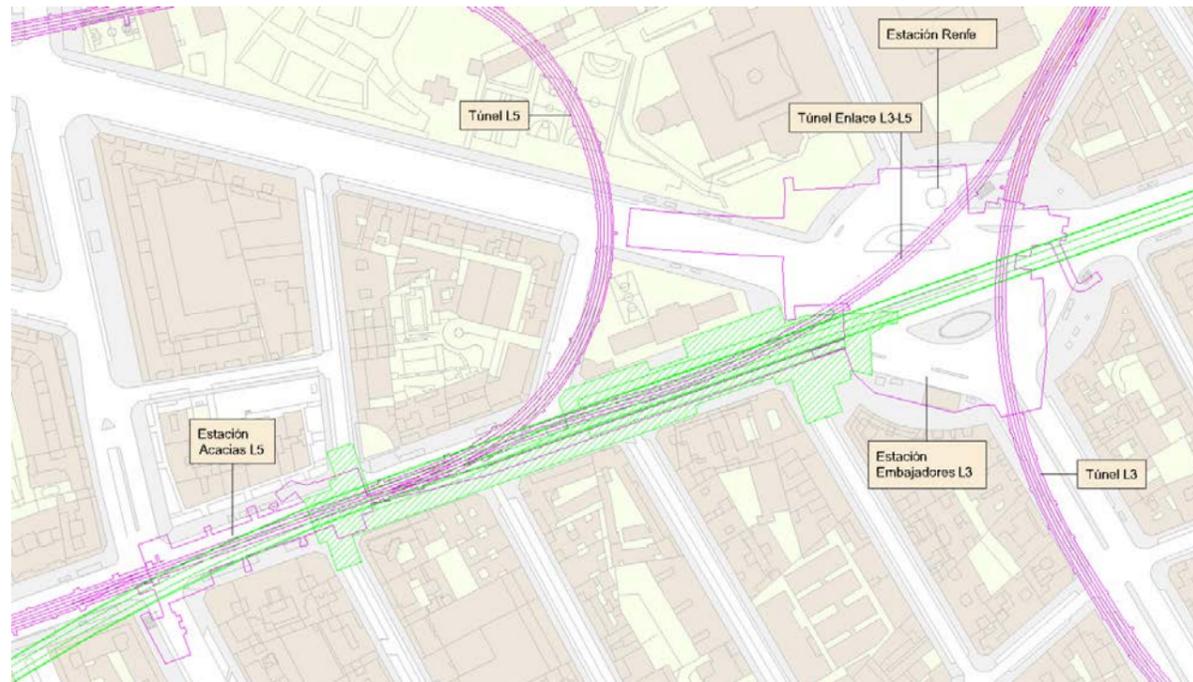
Planta de emplazamiento de la estación Embajadores L11, Alternativa 3.
